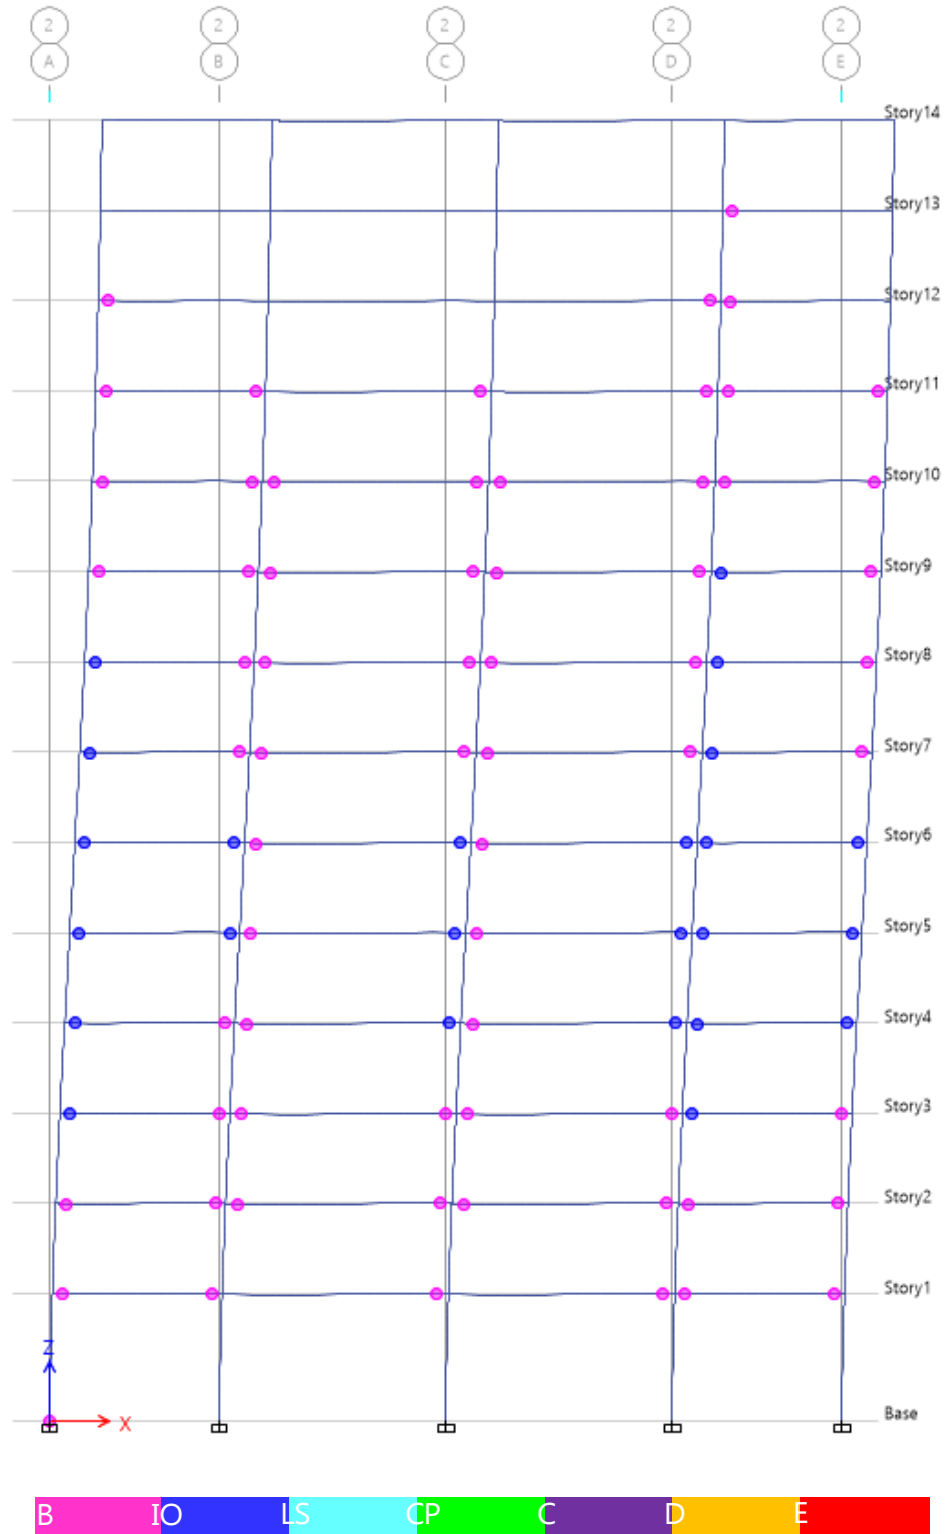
Formulación rótulas plásticas Eje 3 para BSE-1 en dirección x (Pórtico a momento hormigón armado ASCE 7-10).
